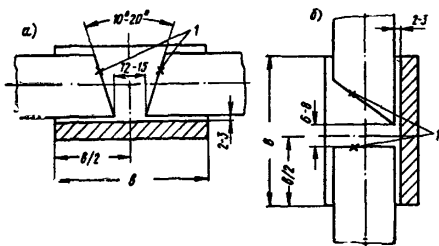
Схема сборки концов подлежащих сварке стержней
